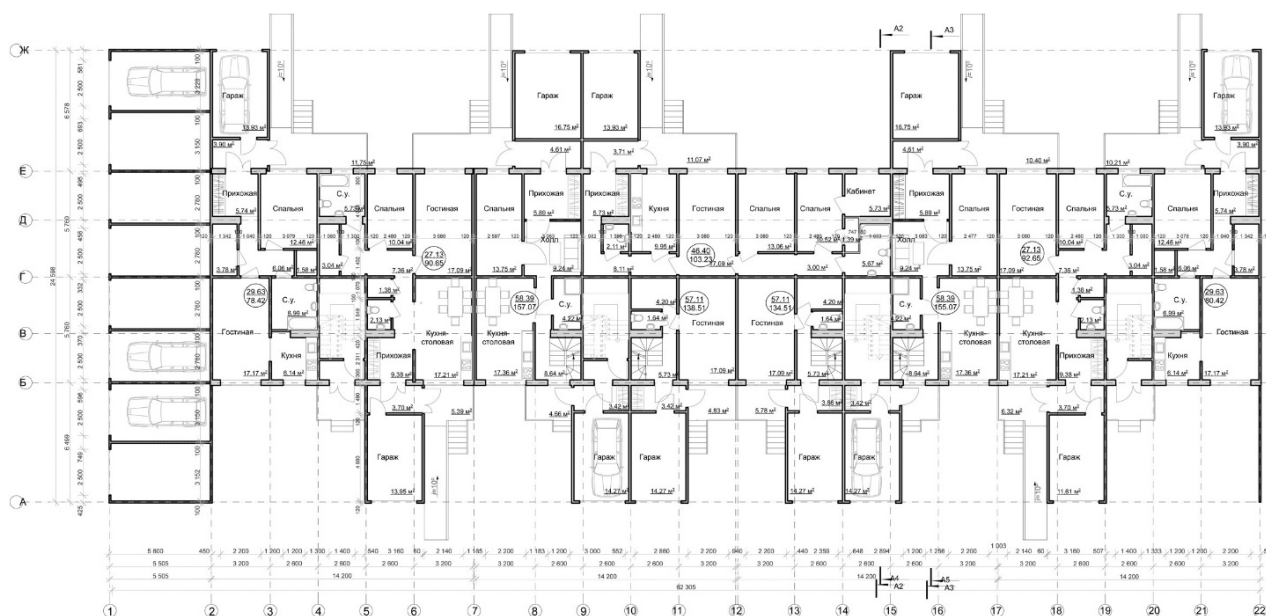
План первого этажа. Реконструкция с переходом от среднеэтажной к малоэтажной застройке
